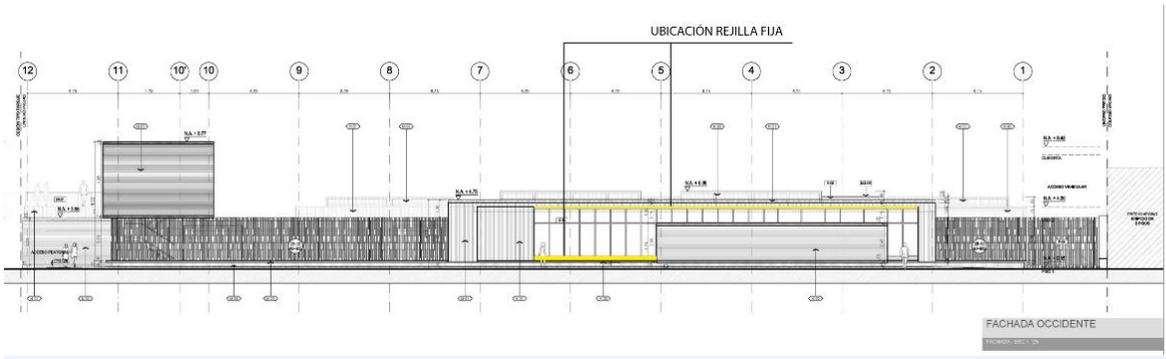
Localización aperturas en fachada occidente A-301 Anexos
